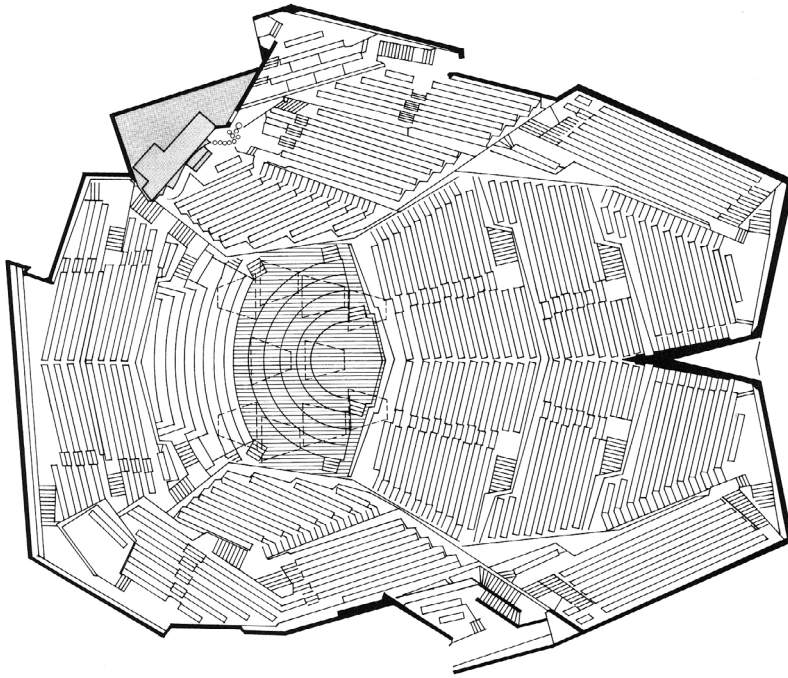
Philharmonie Berlin. Grundriss (Beranek 2004, S. 299)
